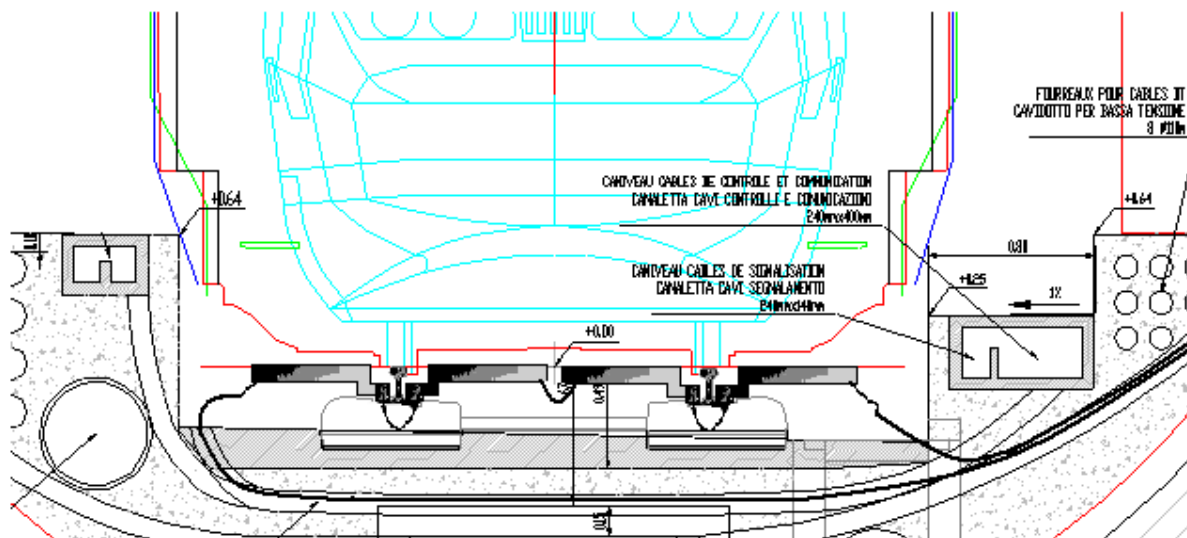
Coupe type en tunnel au lieu d'implantation d'un capteur de détection de déraillement
